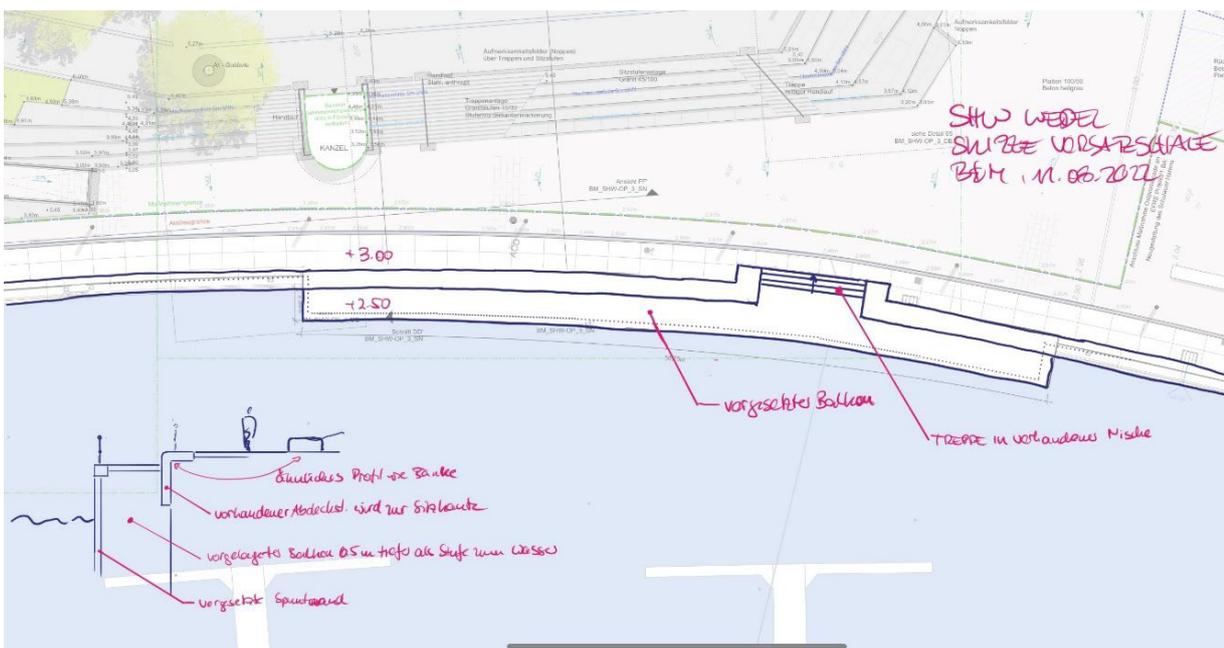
Variante 1A: Balkon (Ideenskizze, Lageplan und Querschnitt)
